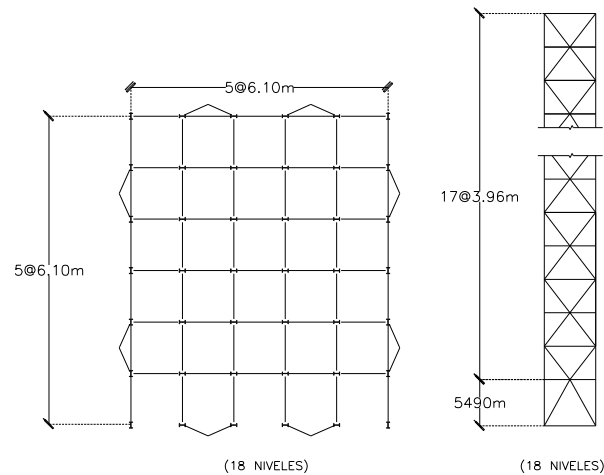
Vista en planta y elevación del marco estudiado (adaptada de Sahoo, 2012)
